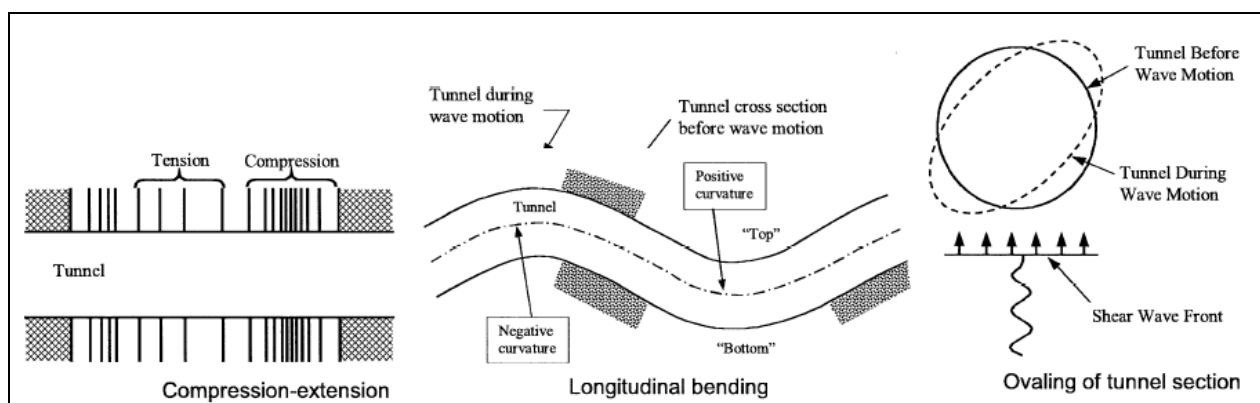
Tipi di deformazione in condizioni sismiche (Owen e Scholl, 1981)
